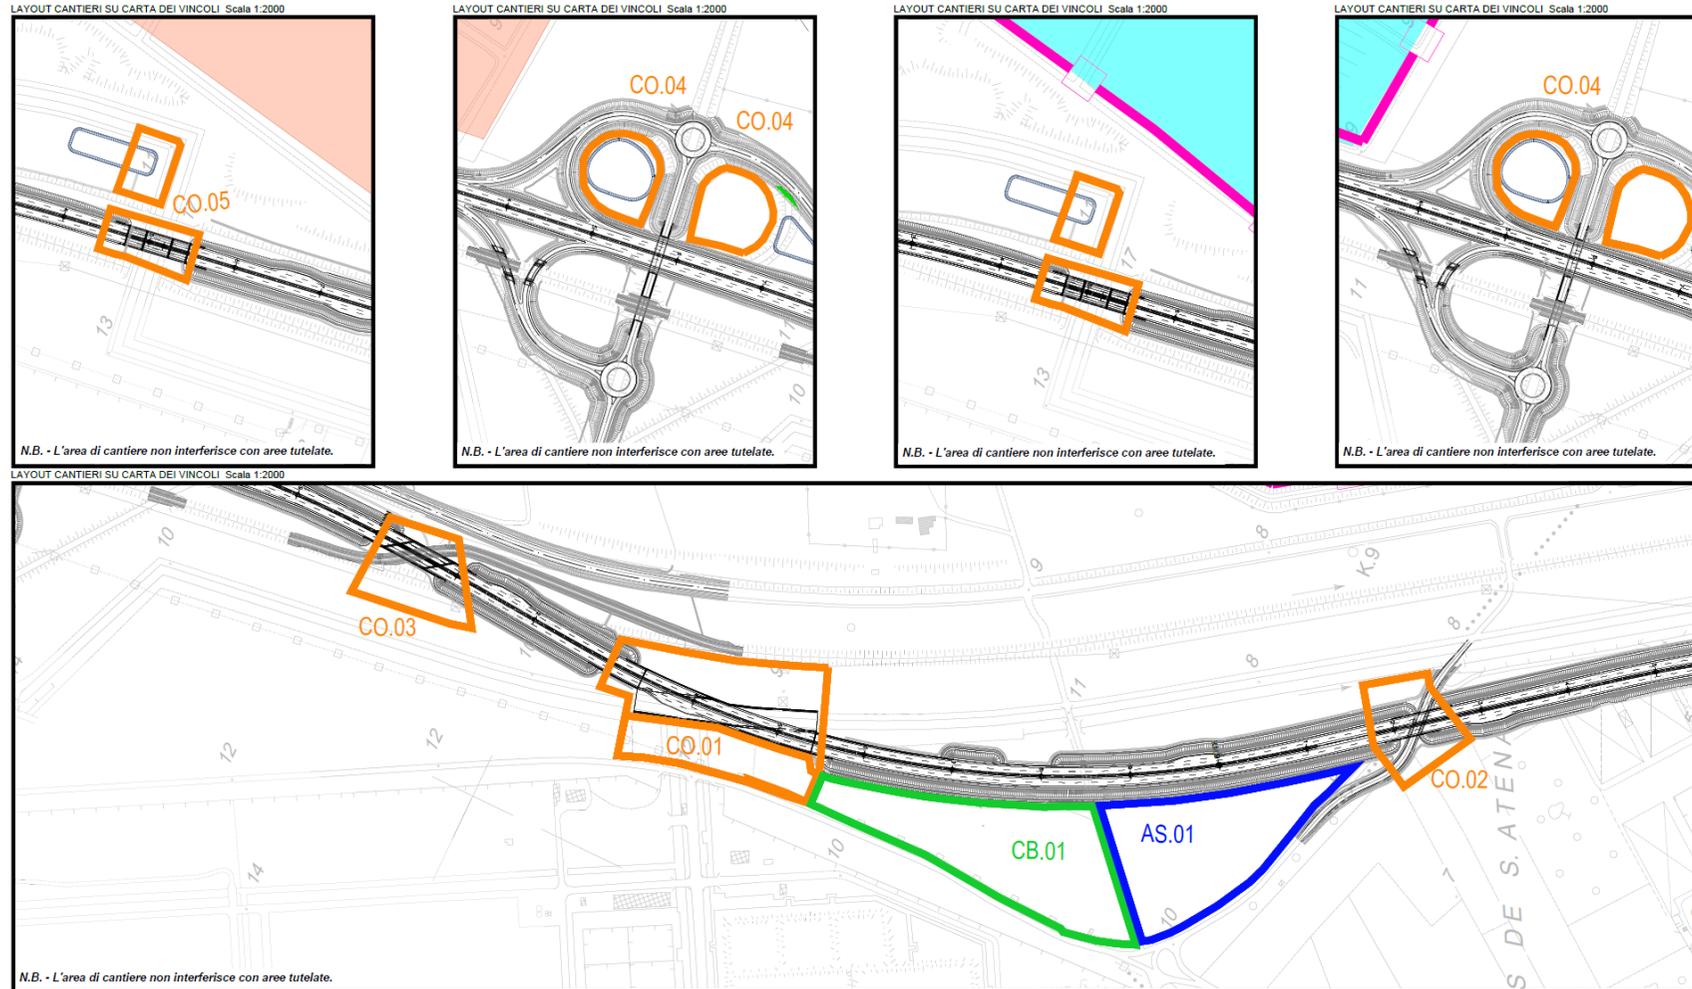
Stralcio delle aree di cantiere su tavola dei vincoli
